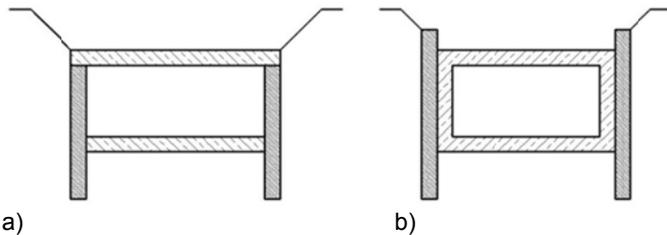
Typen der Tunnelkonstruktion – a) einschalig; b) zweischalig
